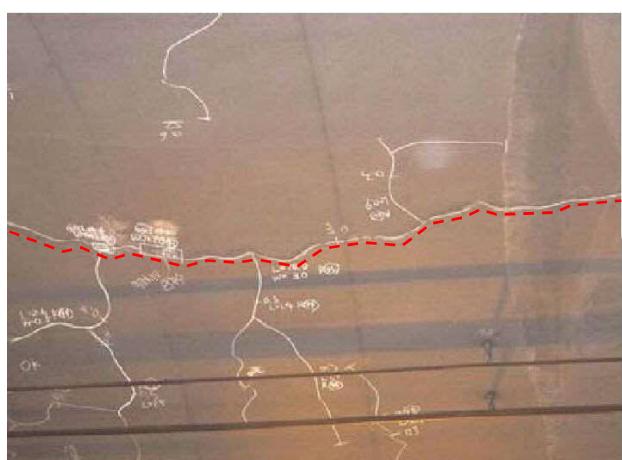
アーチ部の縦断方向ひび割れから発生した横断方向のひび割れ
